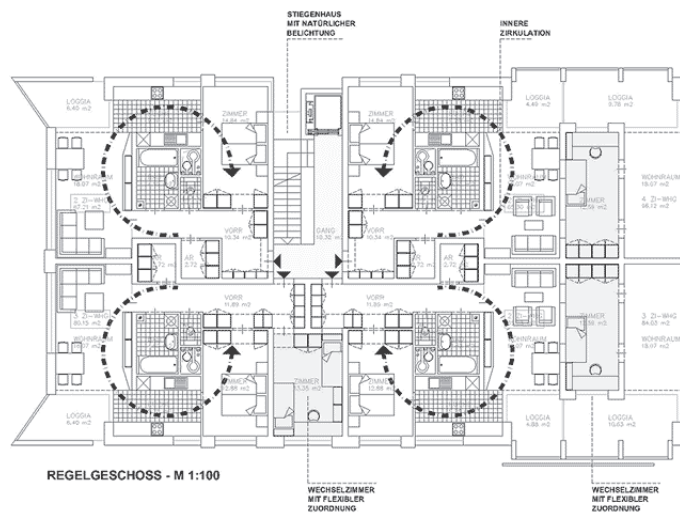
Grundrisse Wienerberger City Mayr-Keber
